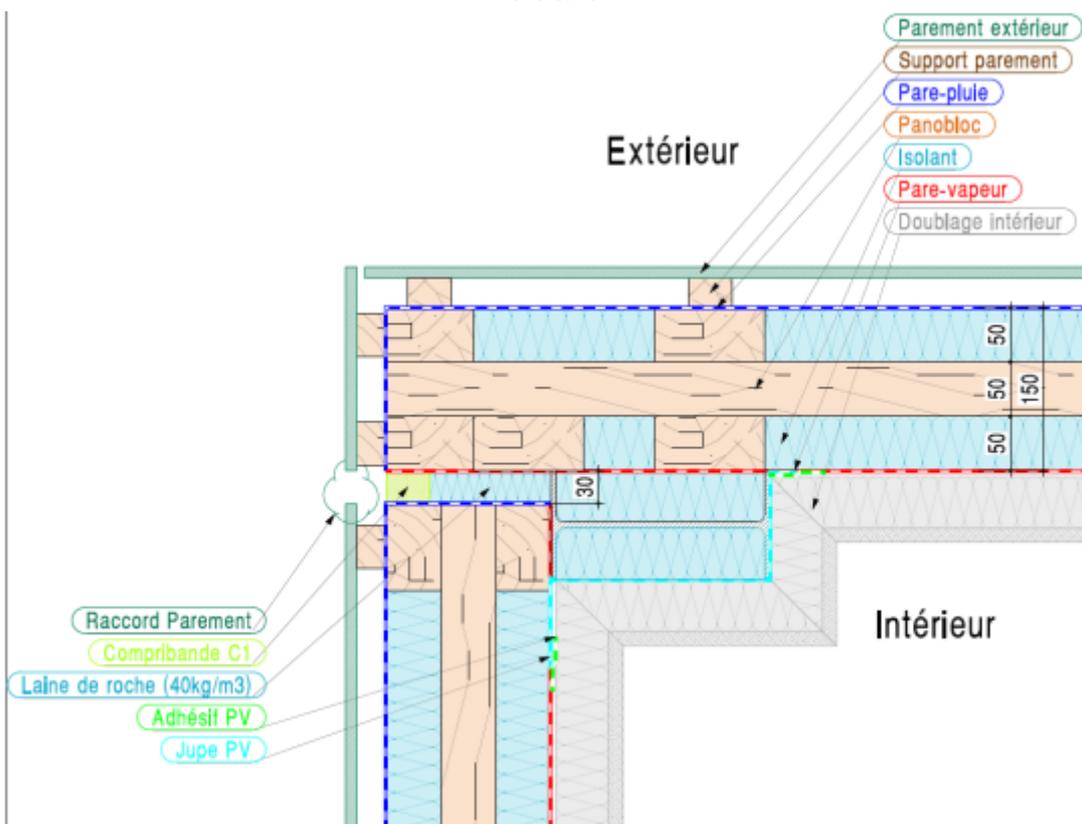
Raccord de panneaux avec poteau d'angle métallique / Coupe horizontale
